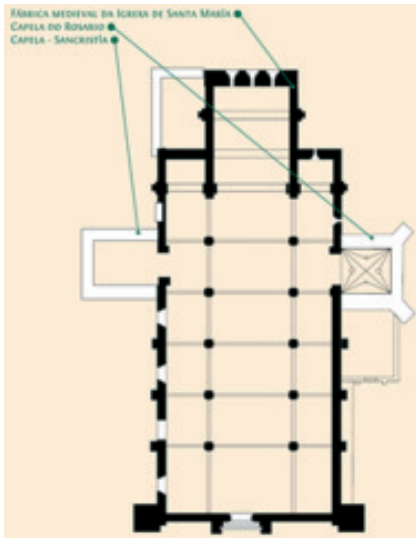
Planta de la iglesia de Santa María de Baiona.
